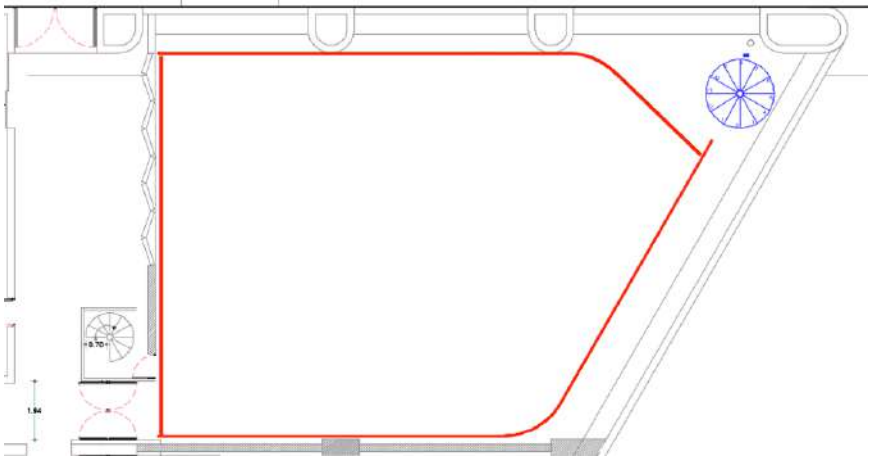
| SISTEMA DE RIELES PARA CORTINA PERIMETRAL
